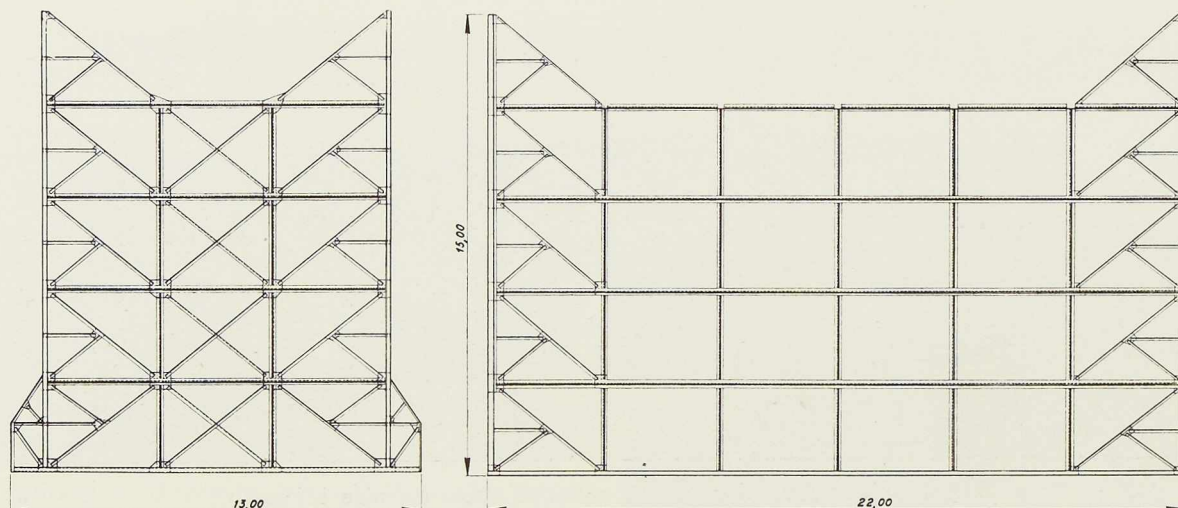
Coupes transversale et longitudinale dans un caisson du type 3 utilisé pour le prolongement de la jetée du large.
